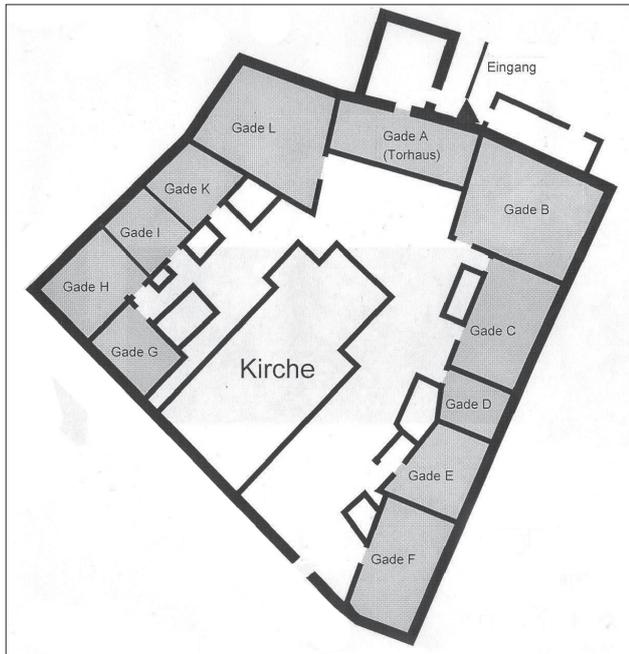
Übersicht Grundriss der Gesamtanlage mit Gadenbezeichnungen (A bis L).
